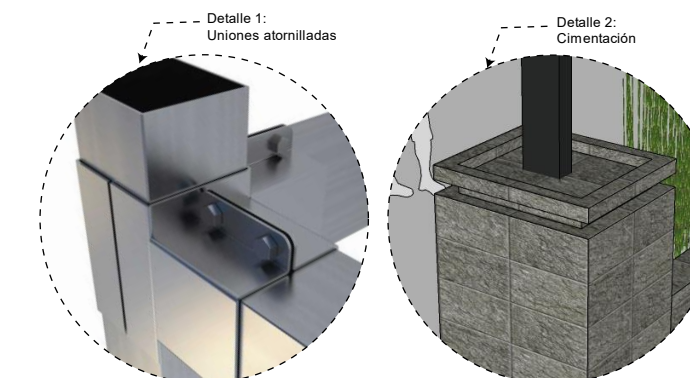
Detalle de uniones atornilladas y cimentación.
